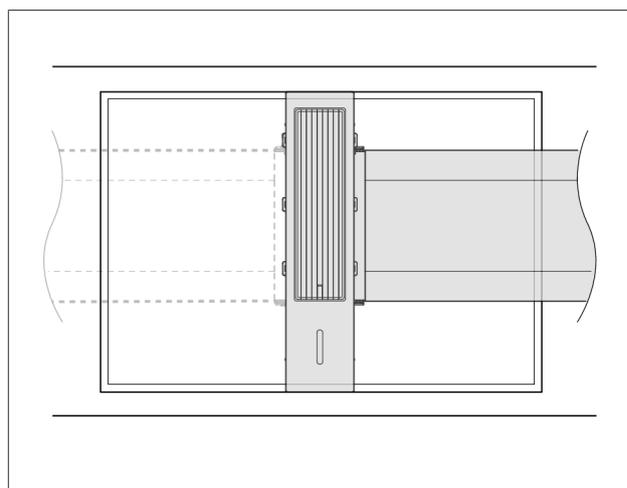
Conduit droit (vers la droite ou vers la gauche)
